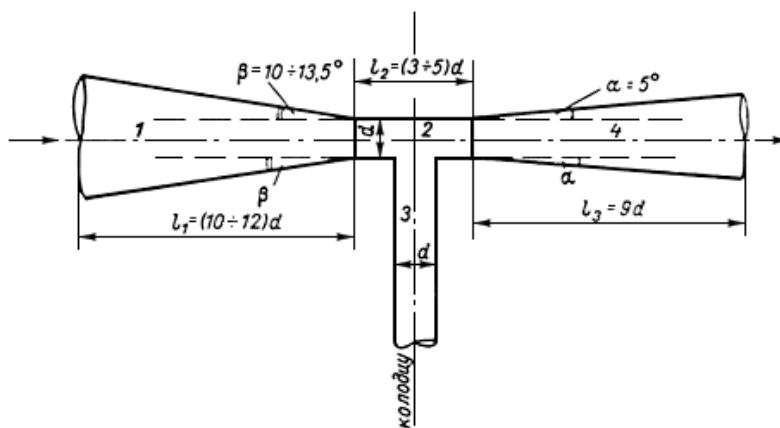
Схема оголовка (речного конца) трубчатого соединительного устройства с насадком Вентури
